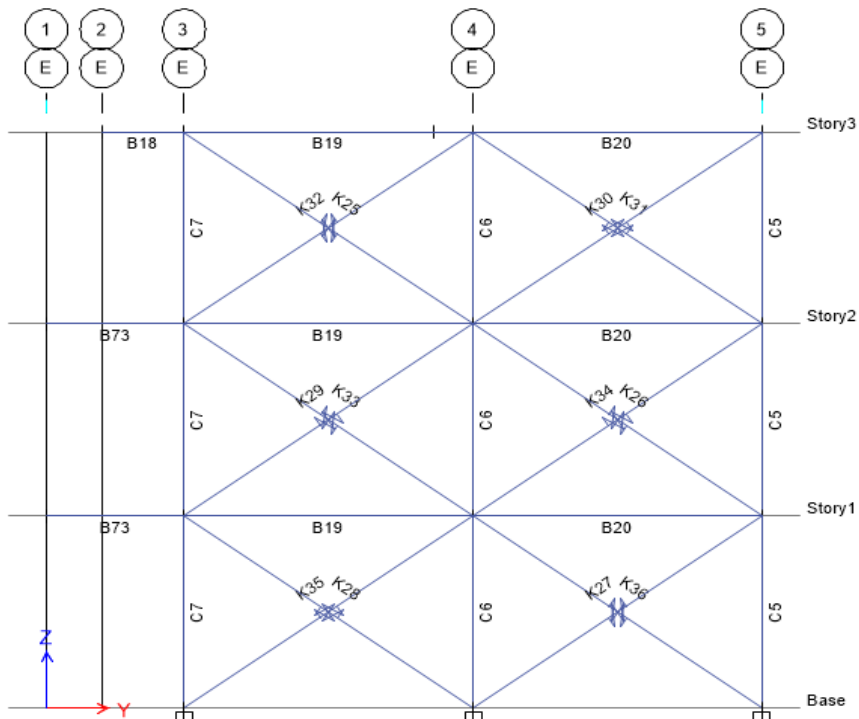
Eje central E de la estructura analizada, donde hay presentes muros de albañilería confinada.
